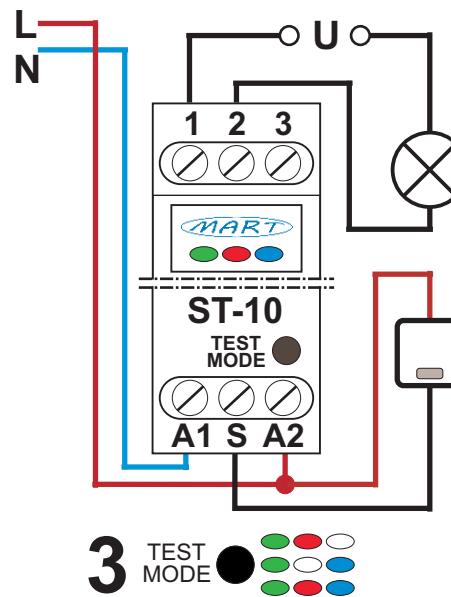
Anschlussplan des TREPPENHAUSSCHALTERS in einer 3-Leiter-Installation.
